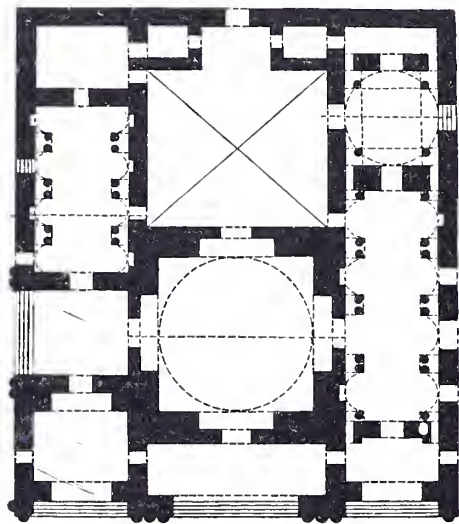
Grundriss des Palastes von Sarvistan.
